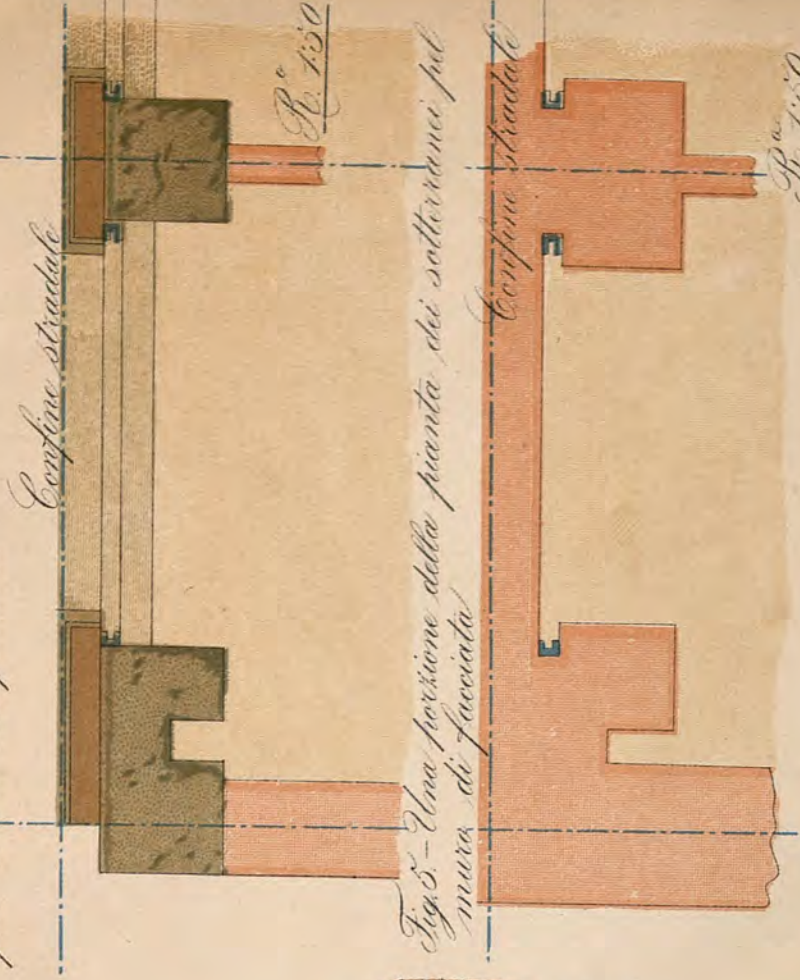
Una porzione della pianta dei sotterranei pel muro di facciata.
